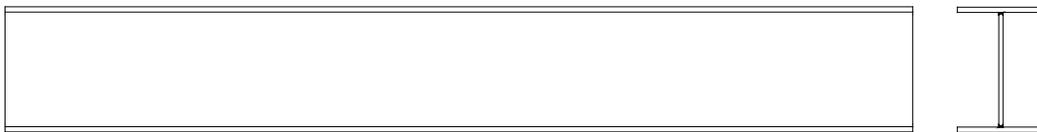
Esquema de las vigas longitudinales (Véase Planos Anexo VII)
